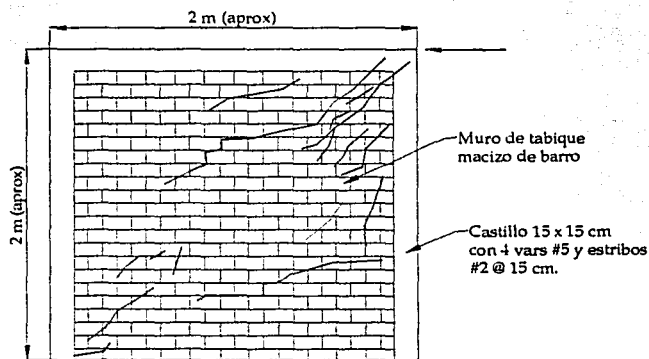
Ensaye en voladizo de un muro de mampostería confinada.
